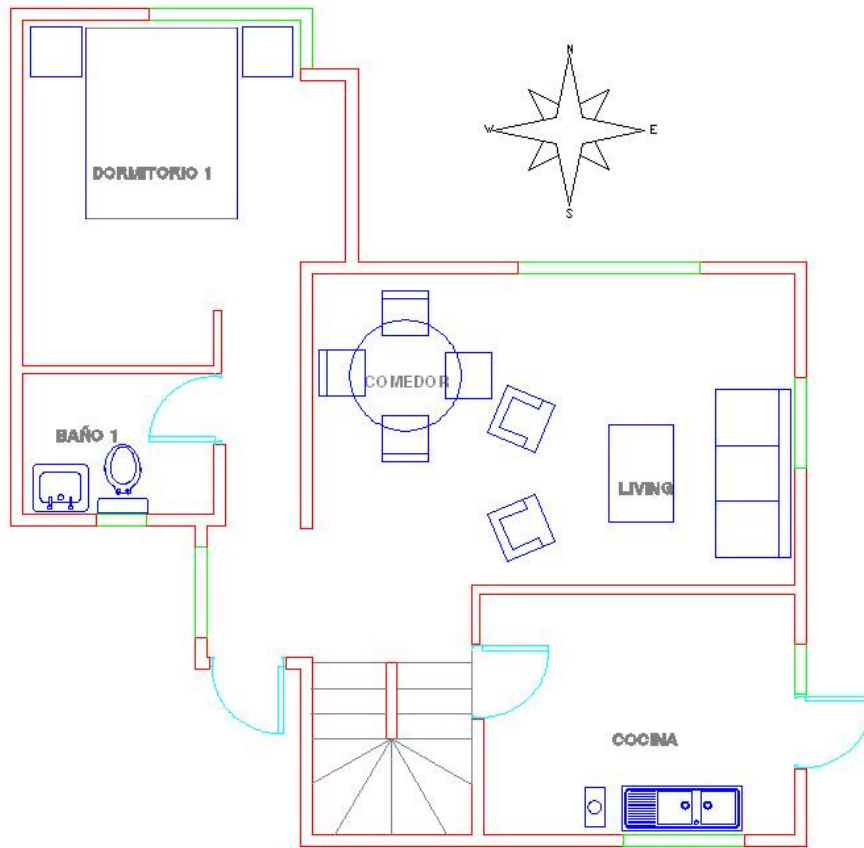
Planta primer piso de la vivienda 2 (modelo Chilco).
